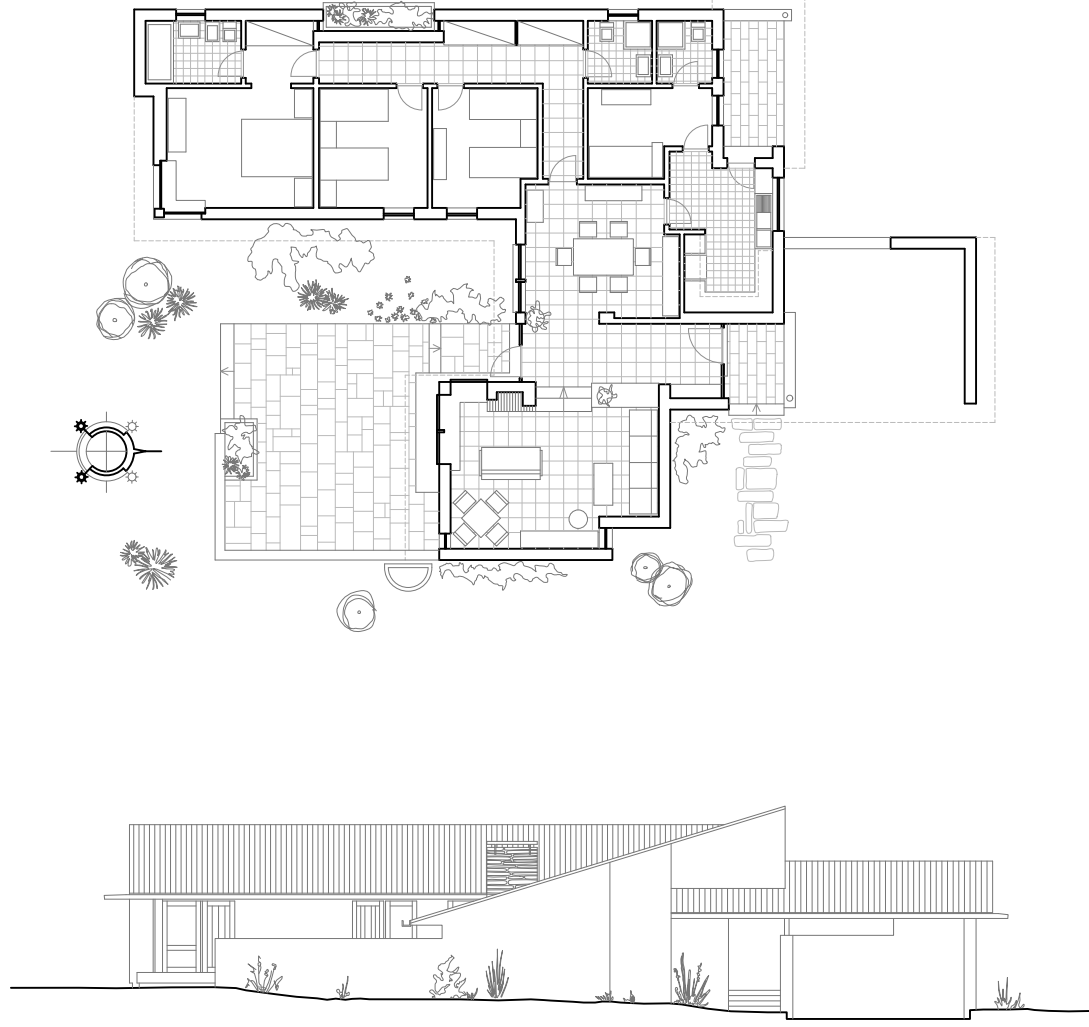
Planta e alçado nascente da Casa Pina Cabral - escala 1.200.
